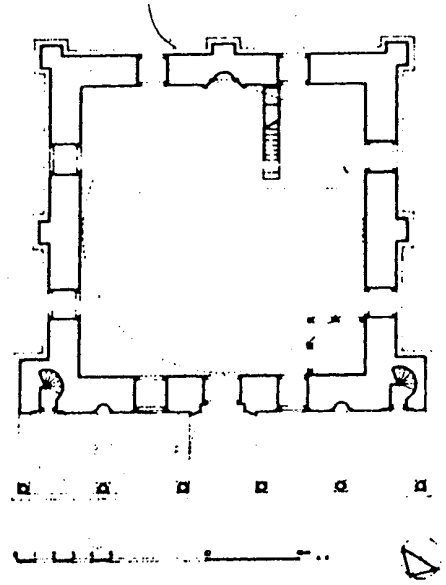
مسقط أفقي لجامع بايزيد يلدريم في مودورنو (عن : Kuran)
